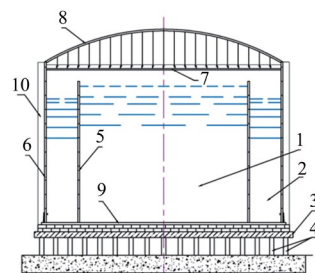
Устройство для хранения сжиженных газов: 1 — основной резервуар для хранения СПГ; 2 — межстенное (резервное) пространство, или аварийный резервуар; 3 — железобетонный ростверк; 4 — сваи; 5 — внутренняя стенка аварийного резервуара; 6 — наружная стенка аварийного резервуара; 7 — внутренняя подвесная крыша устройства; 8 — наружная купольная самонесущая крыша устройства; 9 — общее днище устройства; 10 — наружная теплоизоляция
